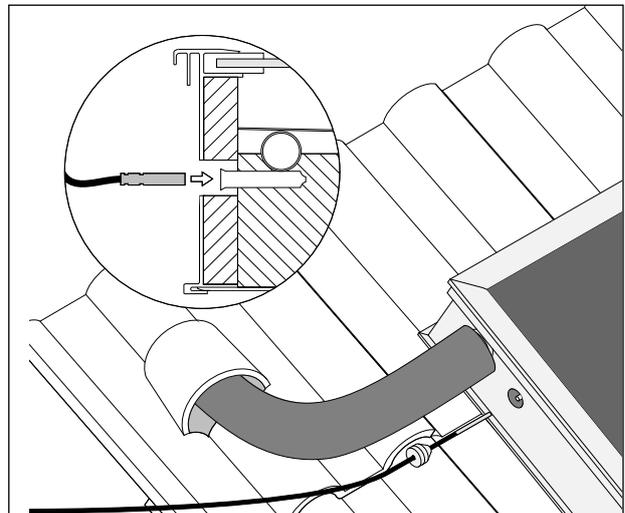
Fühler durch Gummistopfen ziehen und Fühlerspitze in Fühlerhülse stecken. Gummistopfen wieder eindrehen
